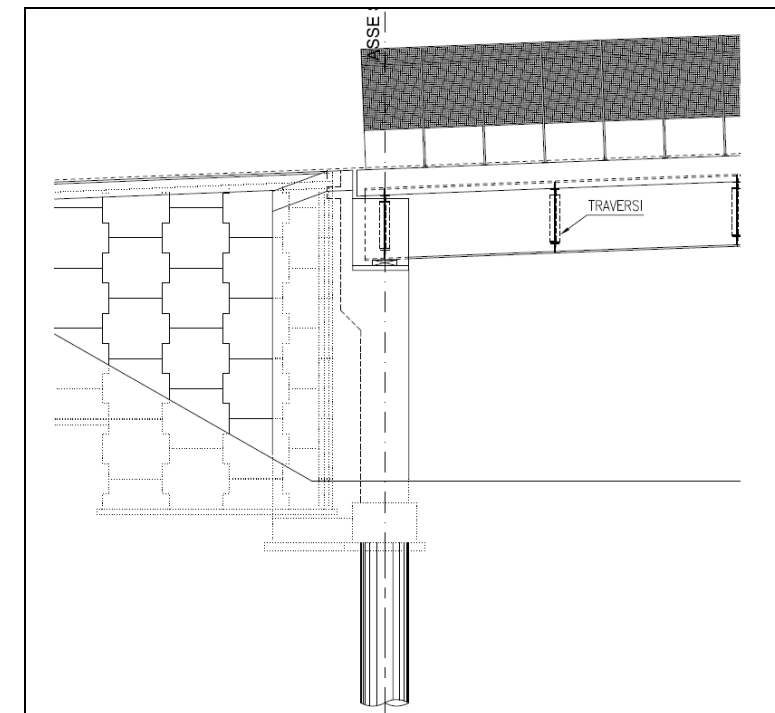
Particolare della fondazione della spalla dei cavalcavia
